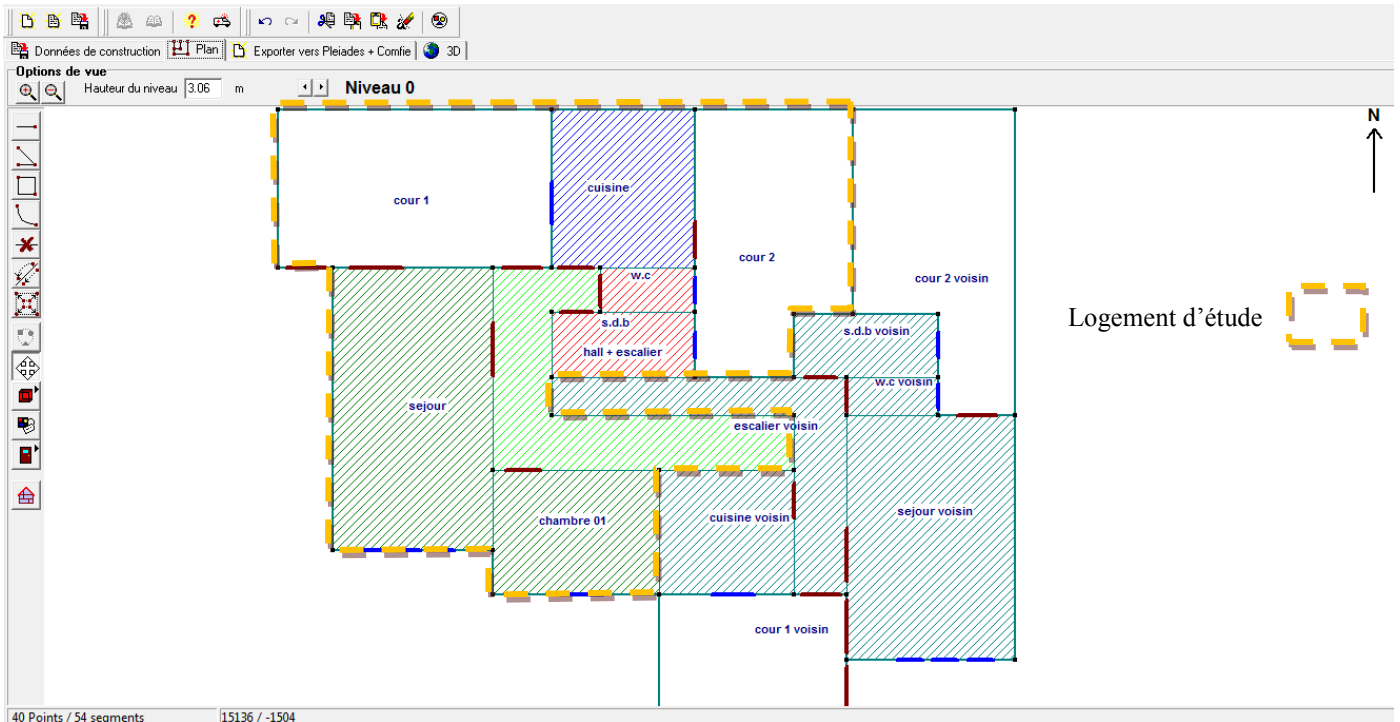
Plan de RDC dessiné par ALCYONE
